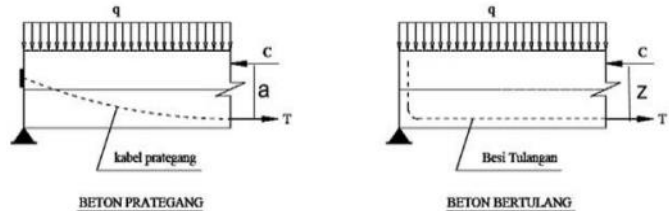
4 Tegangan yang Bekerja pada Beton Prategang
